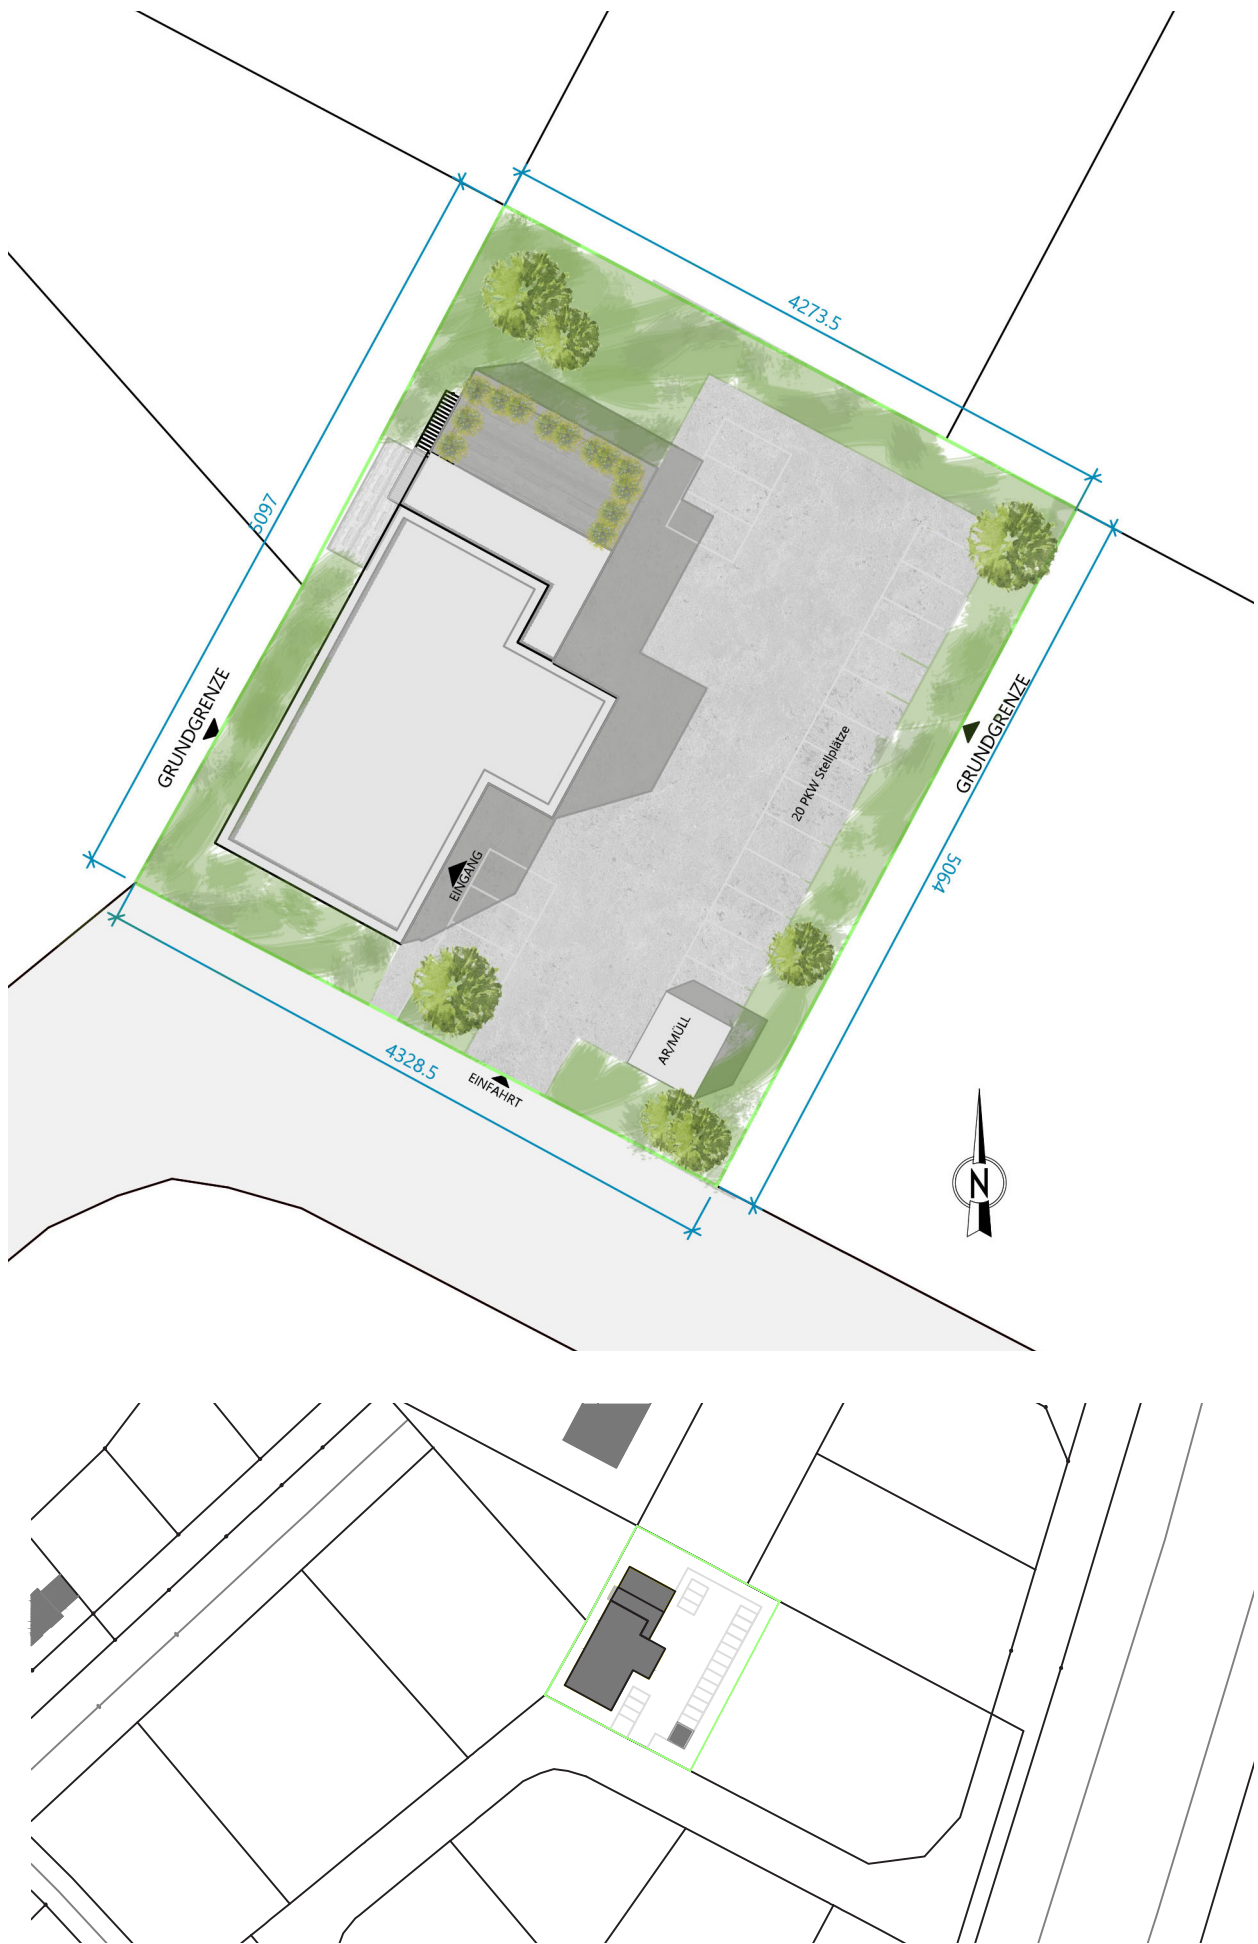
Lageplan M 1:500 (oben) und M 1.:2000 (unten)
